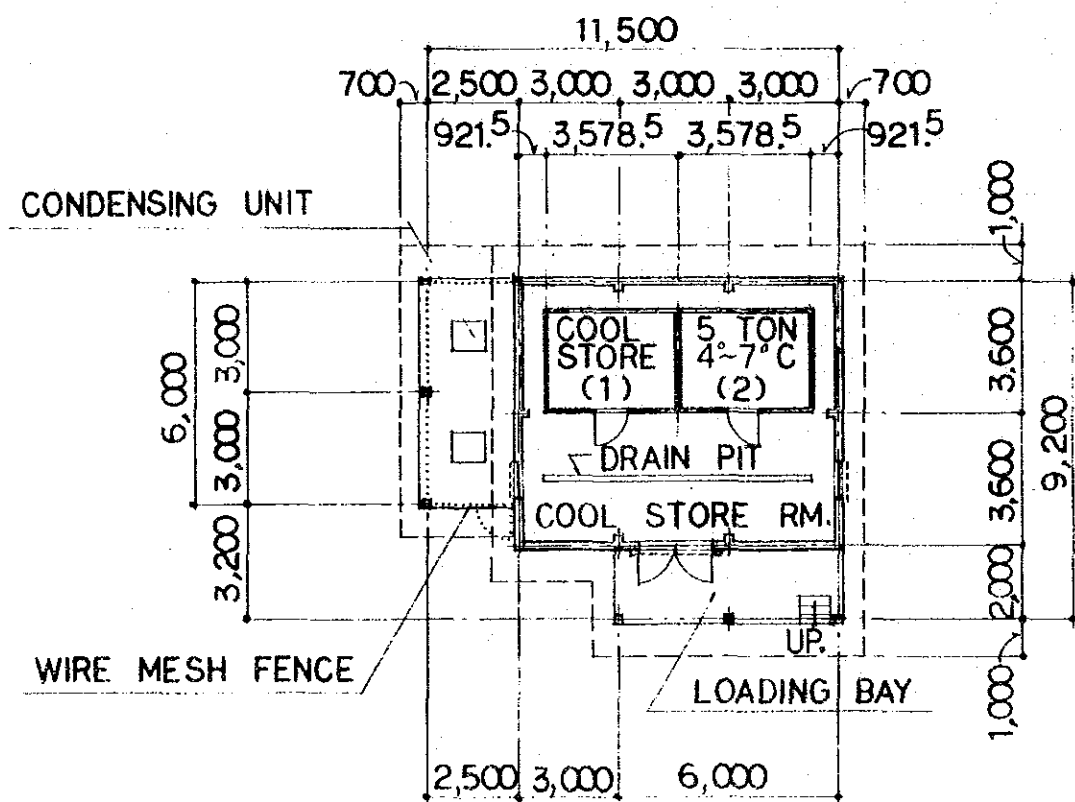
ヴァウワーフィールド空港冷蔵庫平面及び側面図
